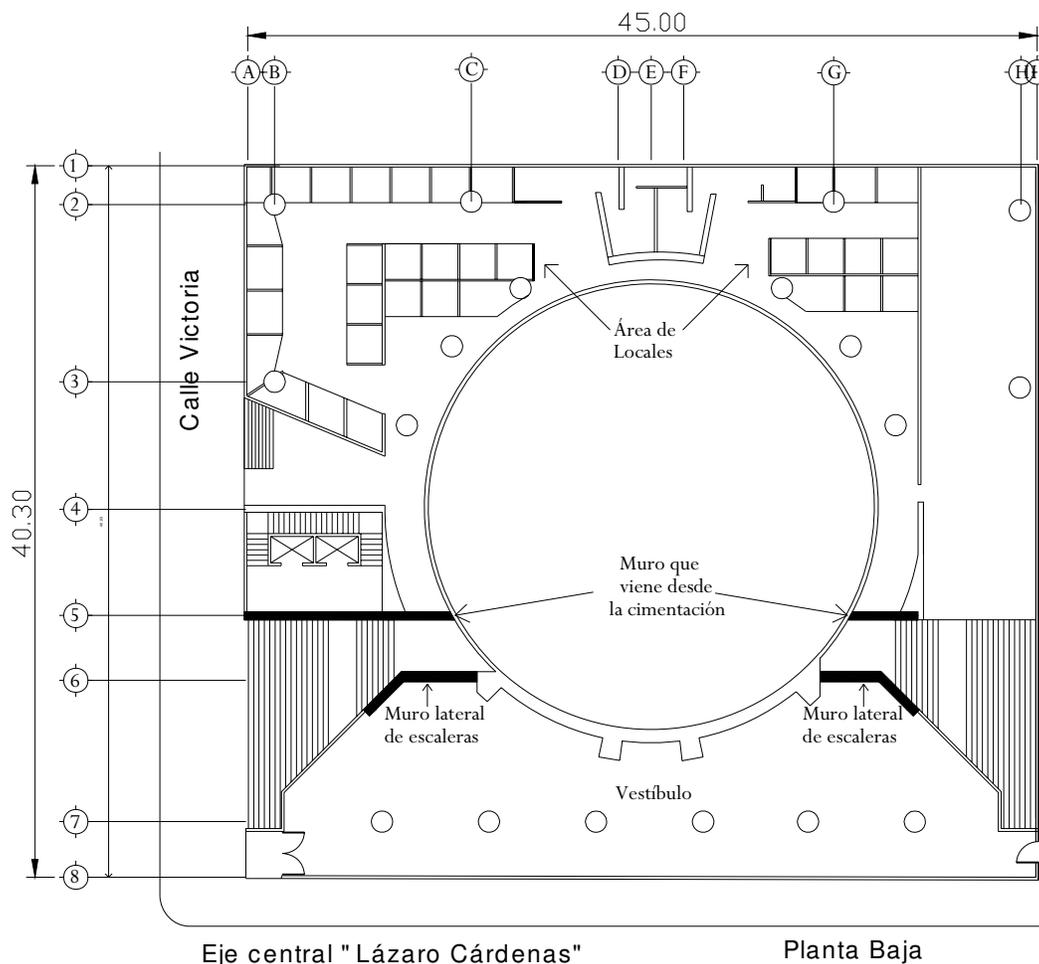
Muros que separaban la zona de locales y la zona del vestíbulo en planta baja, edificio Victoria 7
